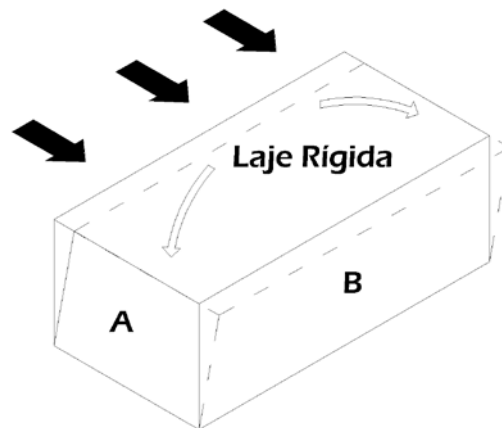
Funcionamento de Laje como Diafragma no travamento da Parede B com a Parede A.
